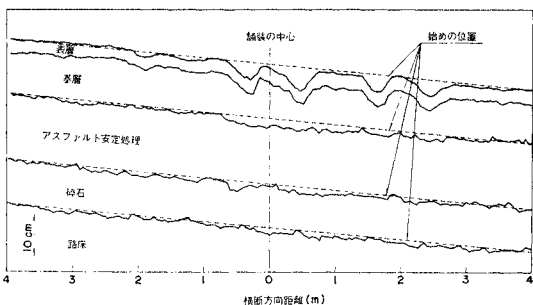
No. 6-1 (AC-3) 舗装の解体断面図
